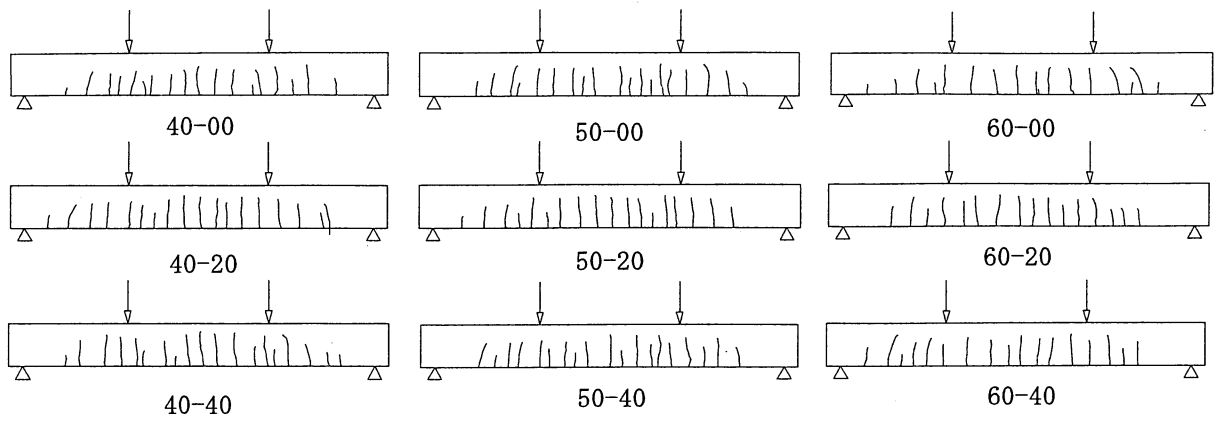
溶融スラグ混入R C部材のひび割れ状況
